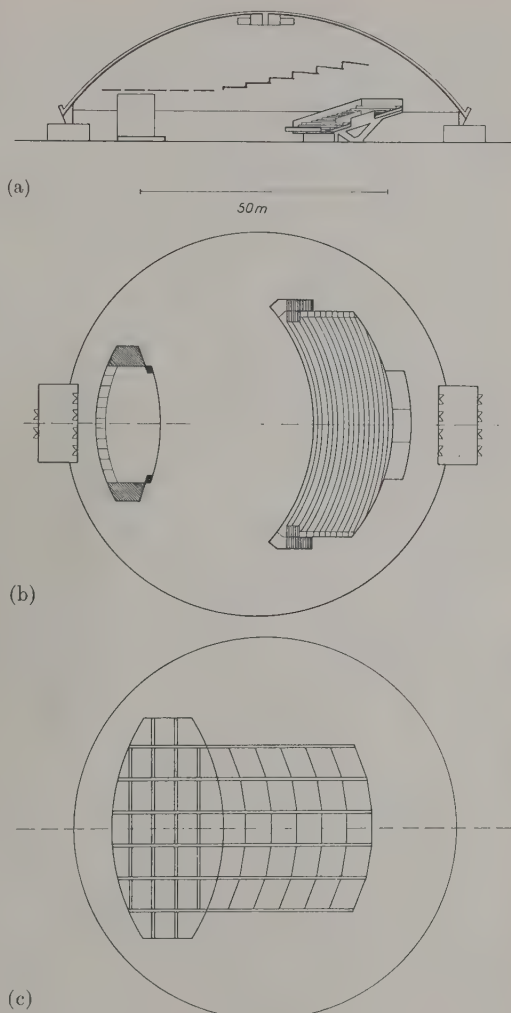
Längsschnitt (a), Grundriß (b) und Aufteilung der Sichtdecke (c) der Festhalle.
